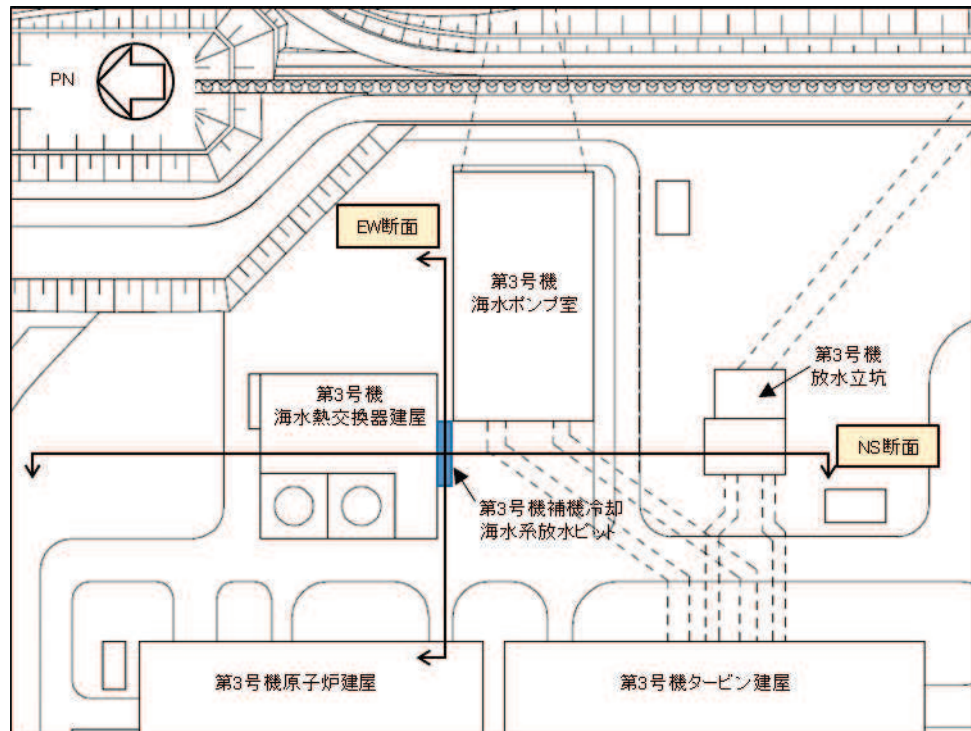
第 3 号機補機冷却海水系放水ピット平面配置図
